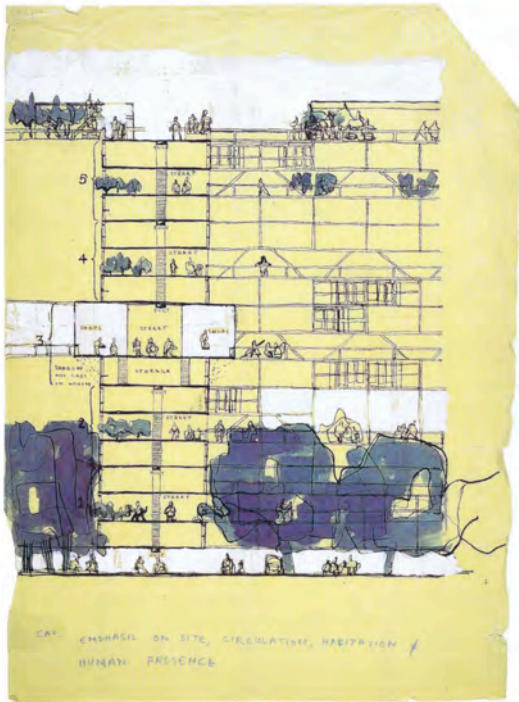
Fachada Sur de la Unidad Vecinal n3
